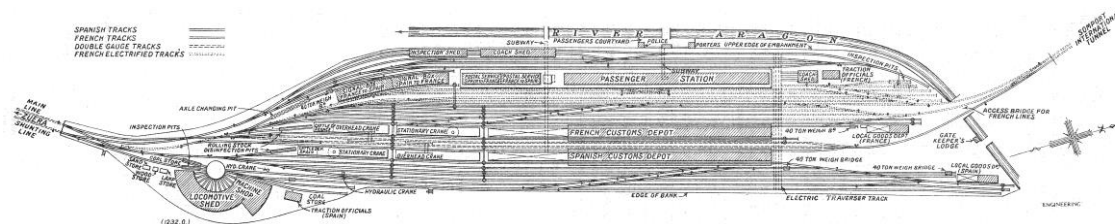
Plano de planta de la Estación Internacional de Canfranc. Fuente: (Rich, 1929).
